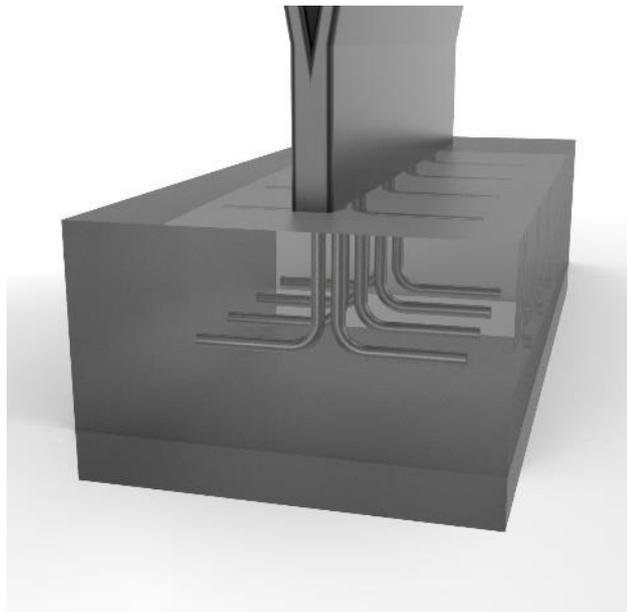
Varillas de acero corrugado para anclaje a zapata de hormigón
